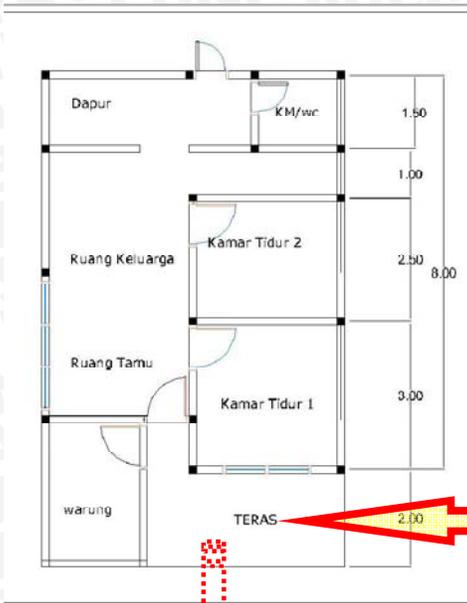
Denah Batas rumah bagian belakang yang sudah bergabung .
